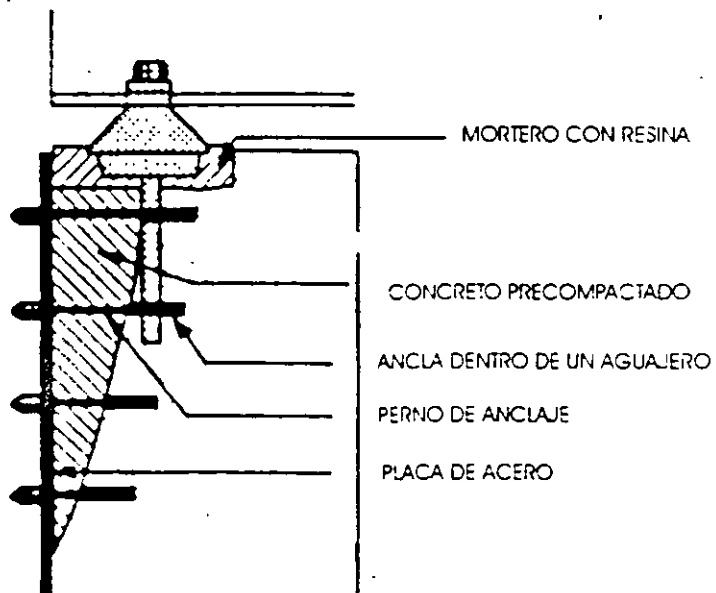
AGRIETAMIENTO DEL CABEZAL DE UNA PILA DE CONCRETO
